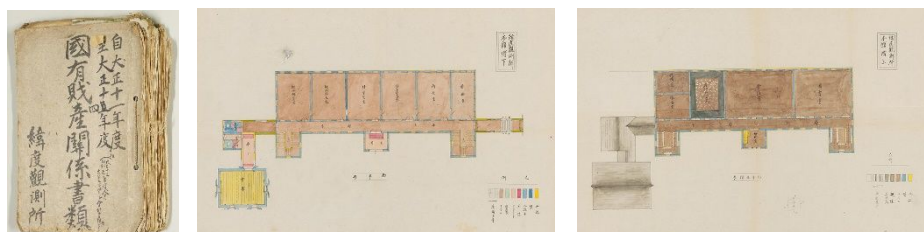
『国有財産関係書類』表紙、第2代本館1階平面図、同2階平面図
